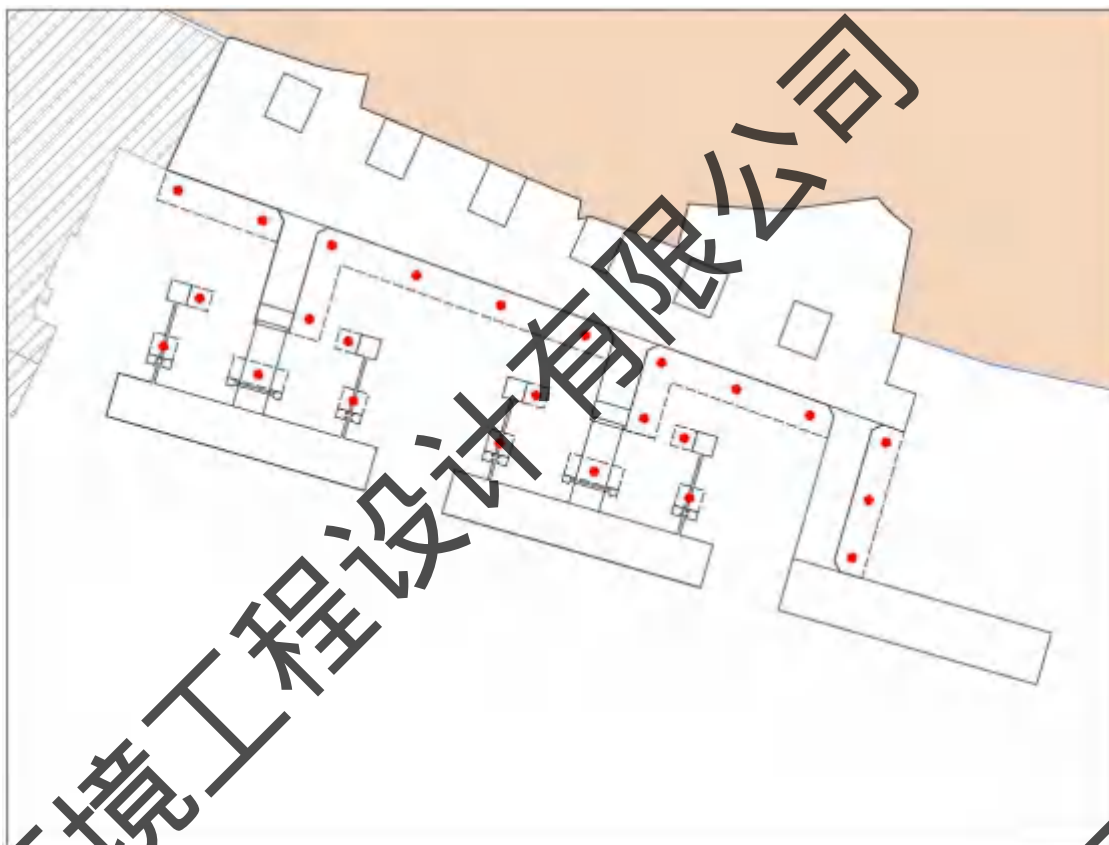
施工平台钢管桩拔桩悬浮泥沙源强点布置示意图
